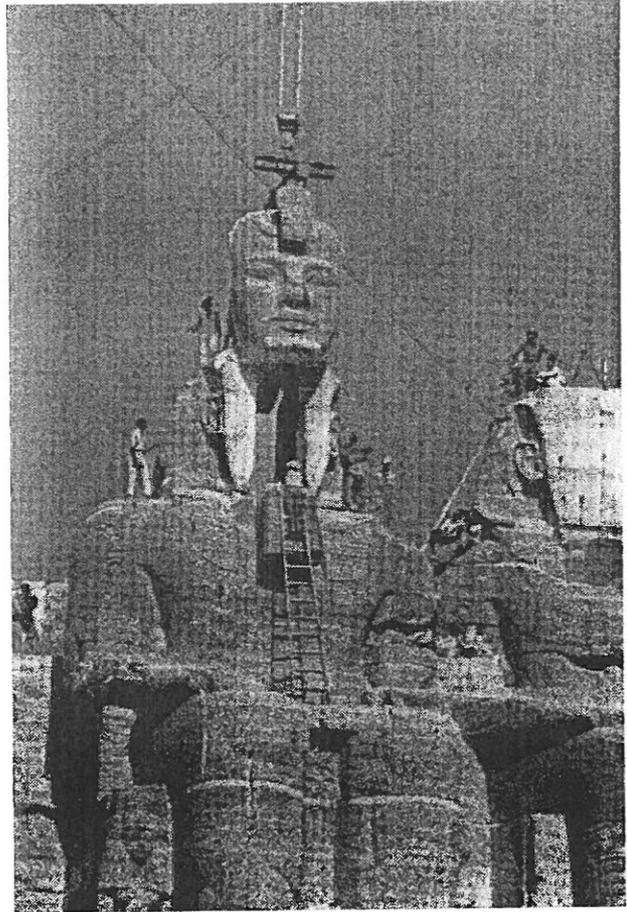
Rimontaggio della testa di Ramsete II.
